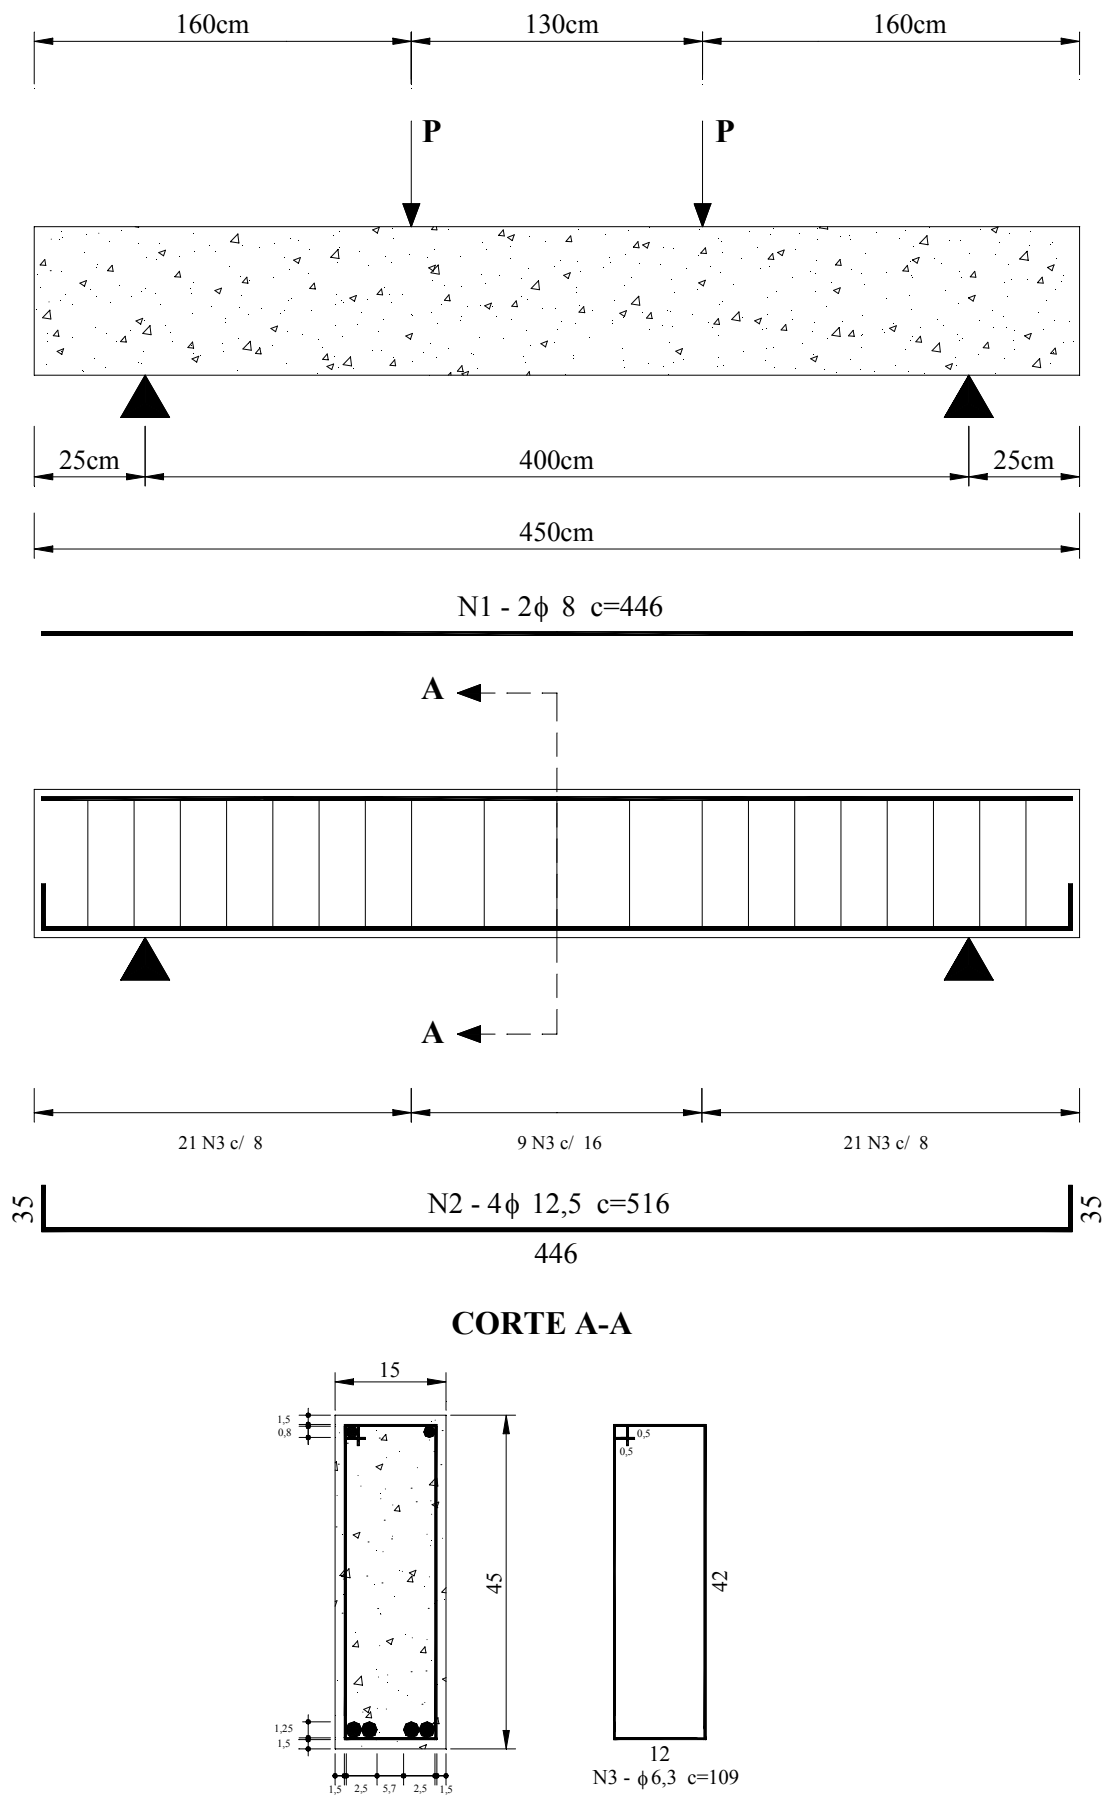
Detalhamento da viga 04 ensaiada por Ribeiro (1996)
